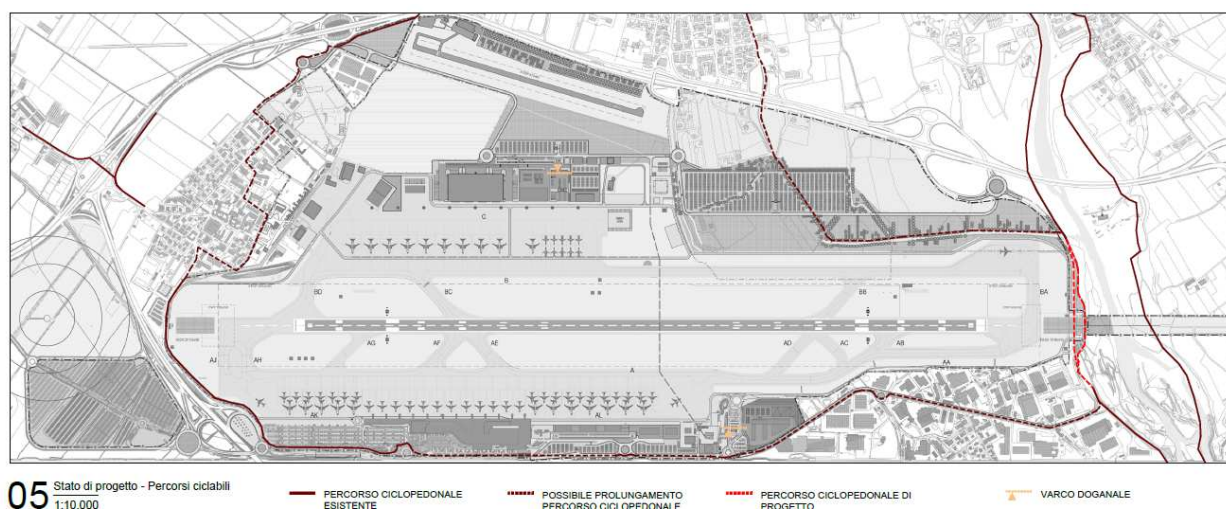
stralcio da planimetria P04\_FLUSSI\_SDP.pdf del SIA
